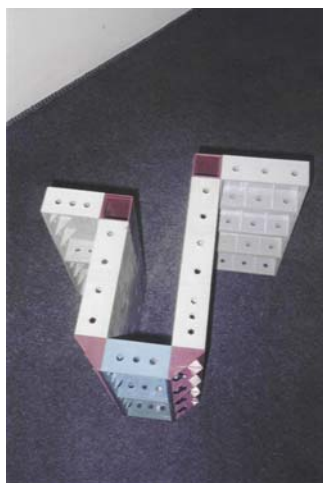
Detalhe da composição das placas formando painel de viga (Madenor).
